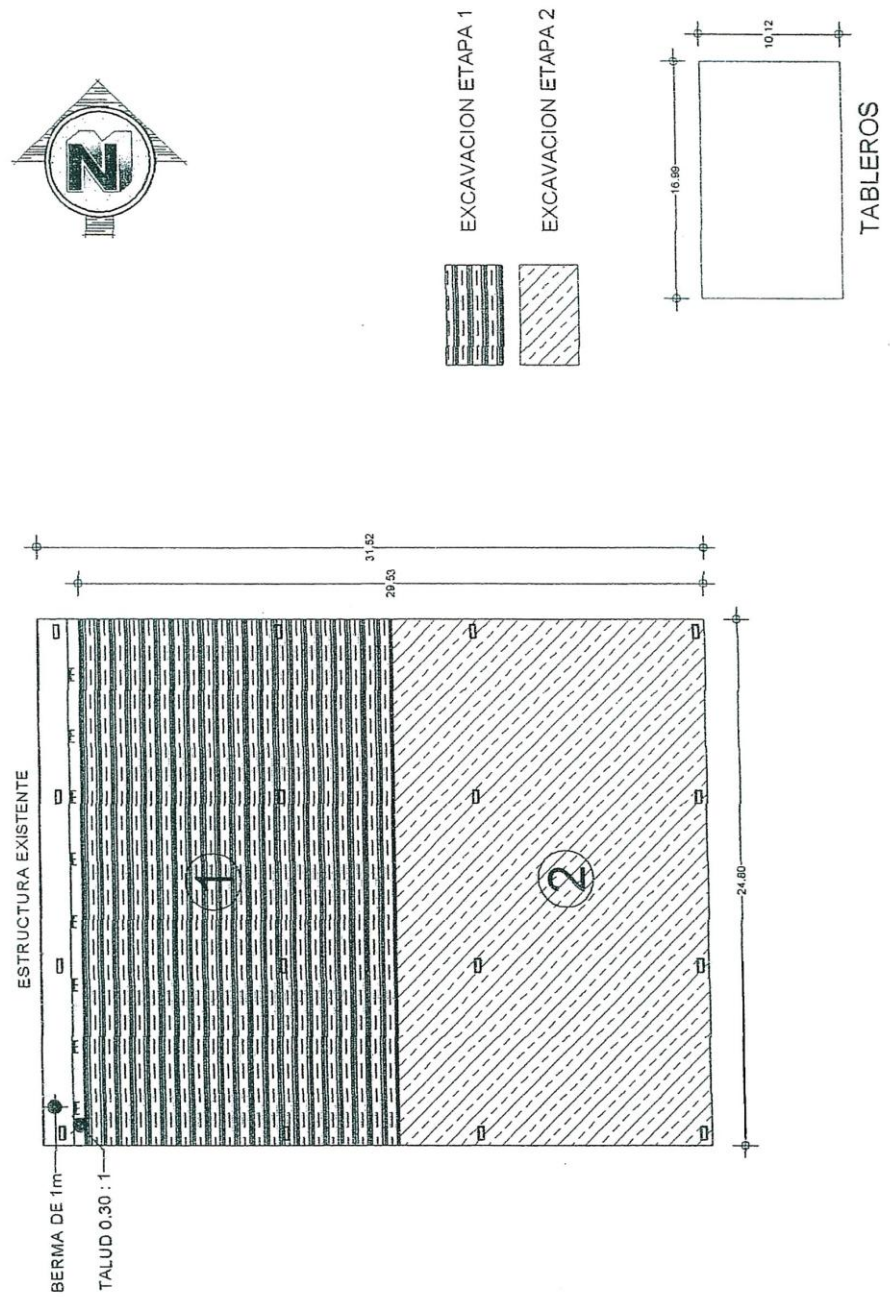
PLANTA DE ETAPAS DE EXCAVACION ESTRUCTURA II (TERAPIA)
